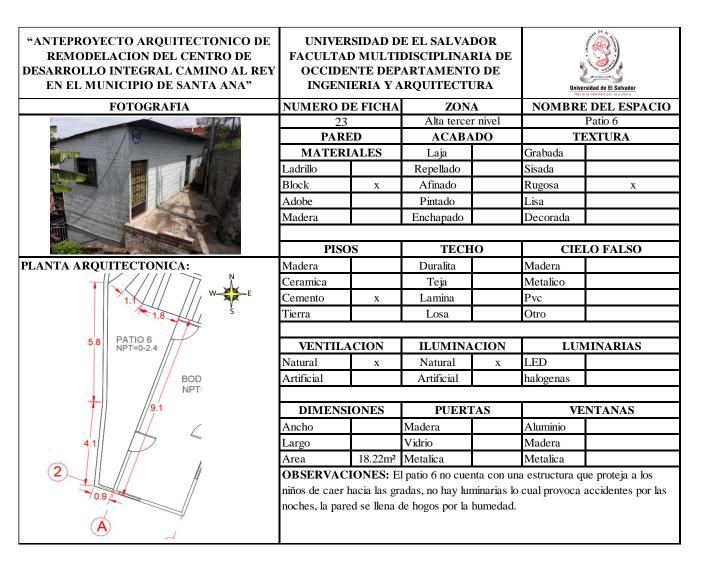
Planta arquitectónica alta tercer nivel. Elaboración propia.
